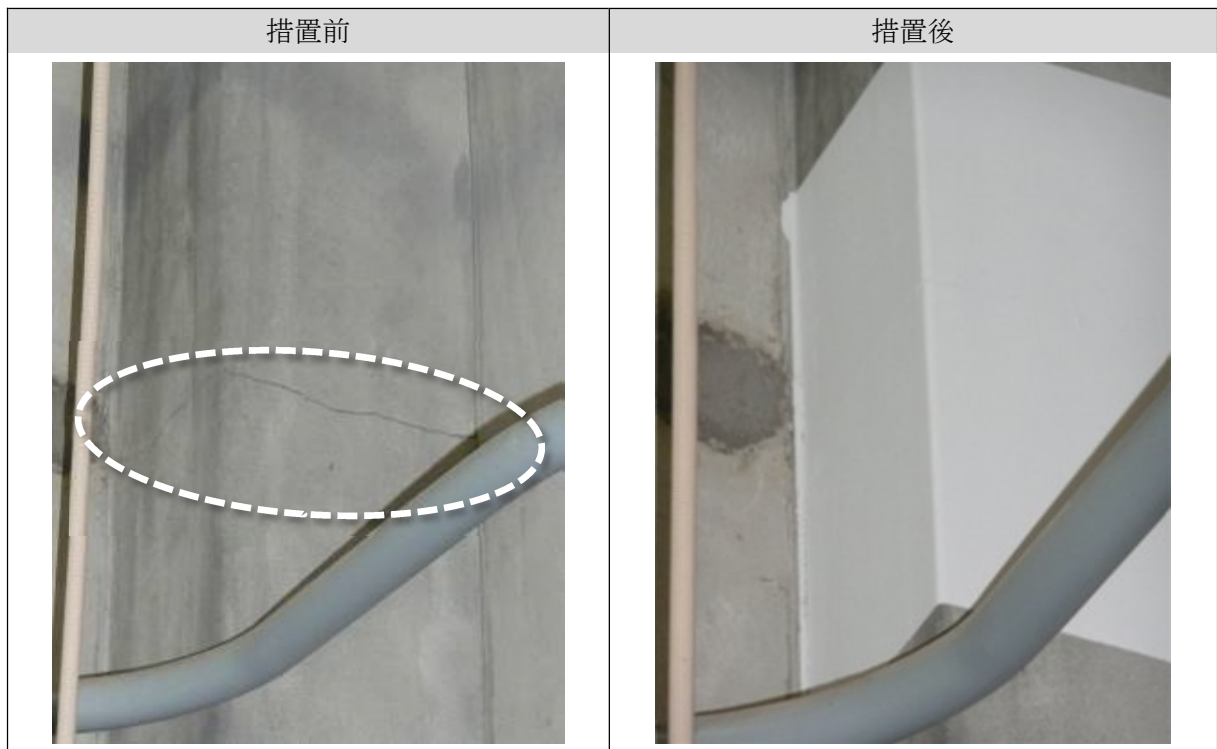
鉄筋コンクリート構造の柱のひび割れ
